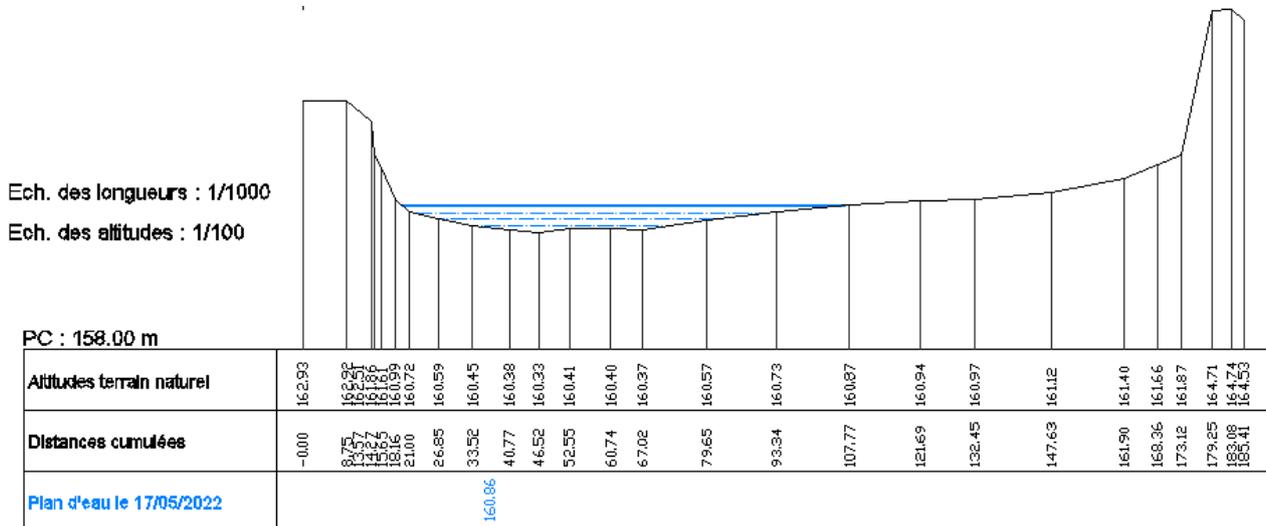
Profil en travers au droit de la zone en eau dans l'étang (Source : HYDROTOPO)
